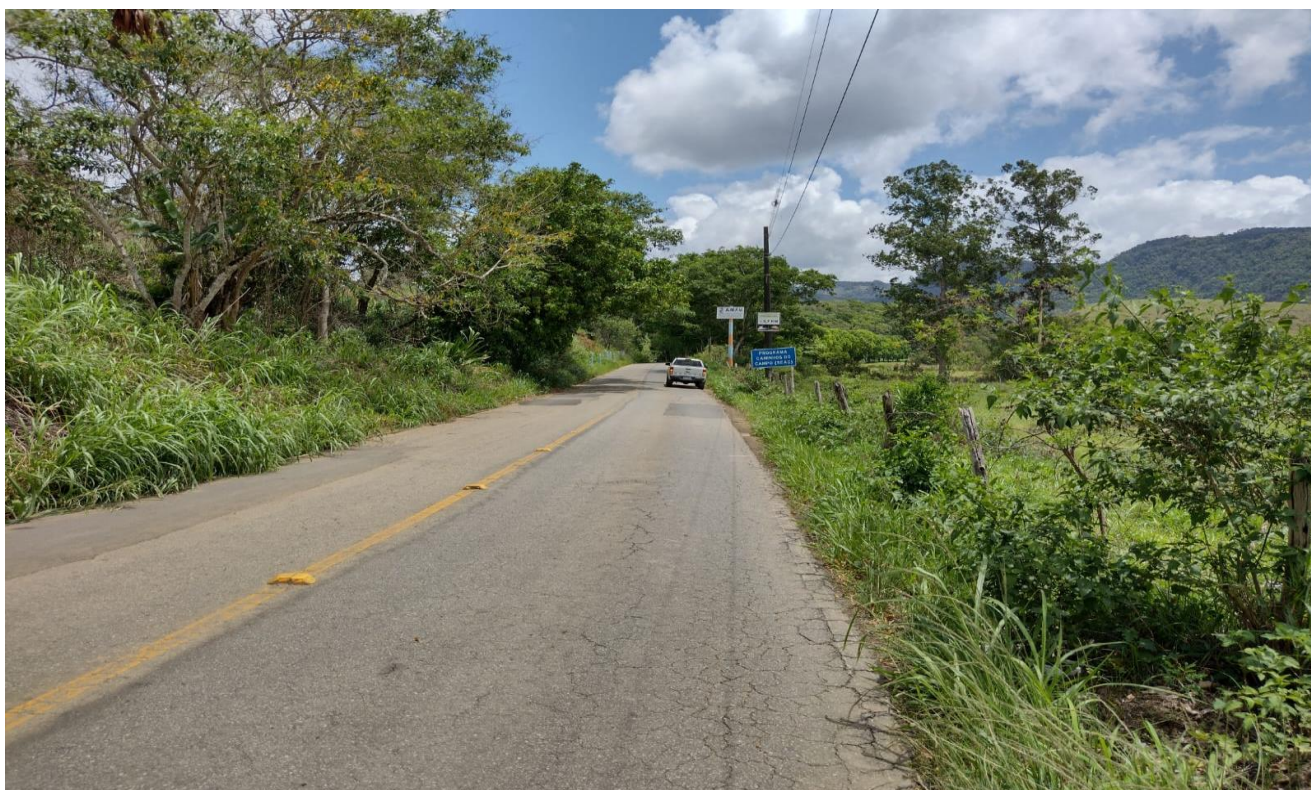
Imagens da área pretendida para a instalação do Canteiro de obras de Viana - ES, às margens da rodovia BR 262.
